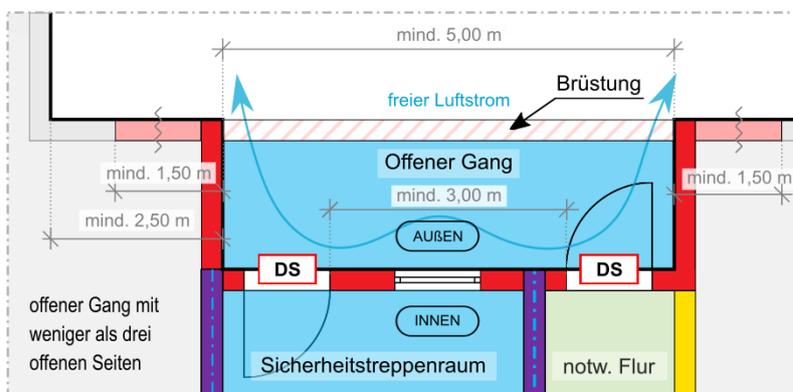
Prinzipskizze (Grundriss) - außenliegender Sicherheitstuppenraum mit offenem Gang mit weniger als drei offenen Seiten
